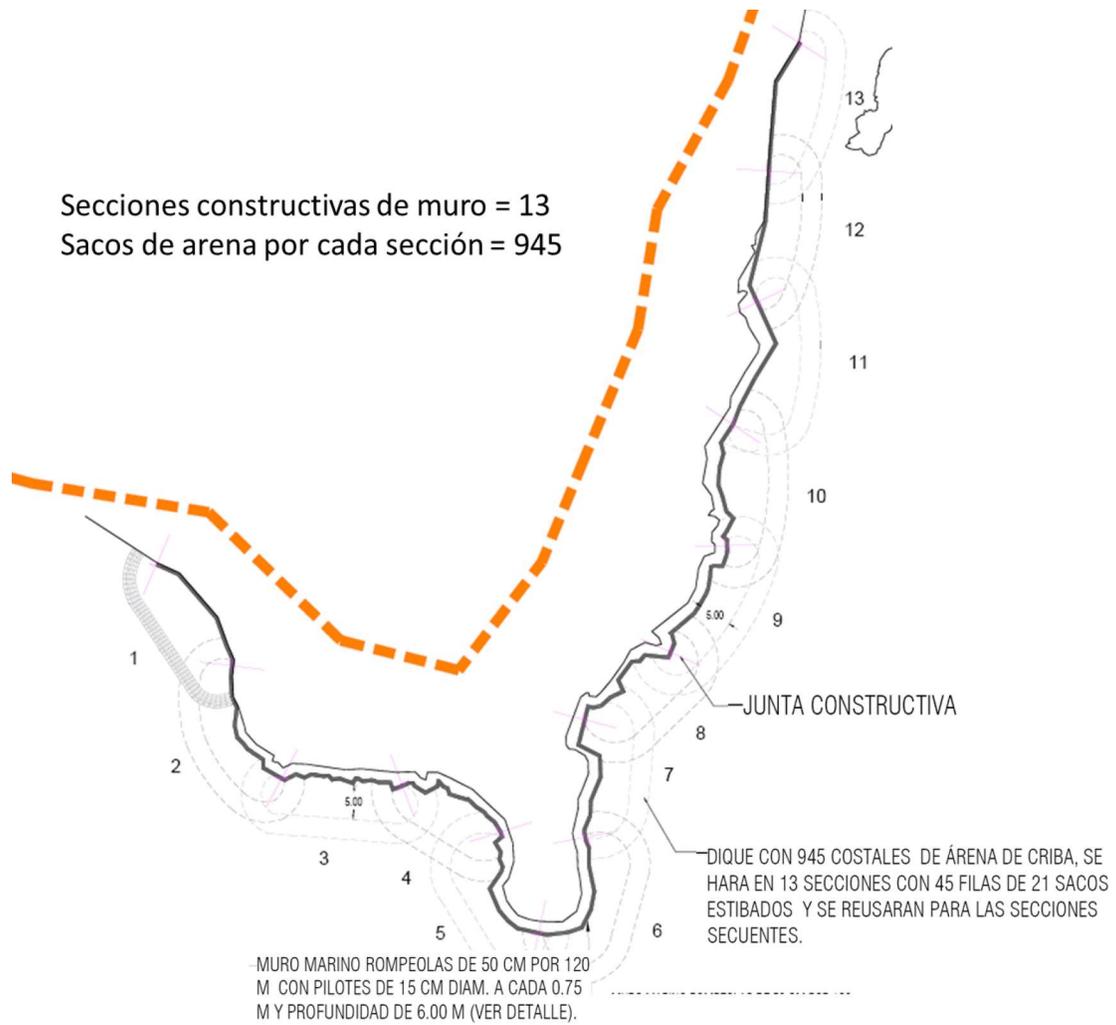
PLANTA DE RELLENO DE CONCRETO ENTRE EL MURO Y LA BASE DEL CANTIL
